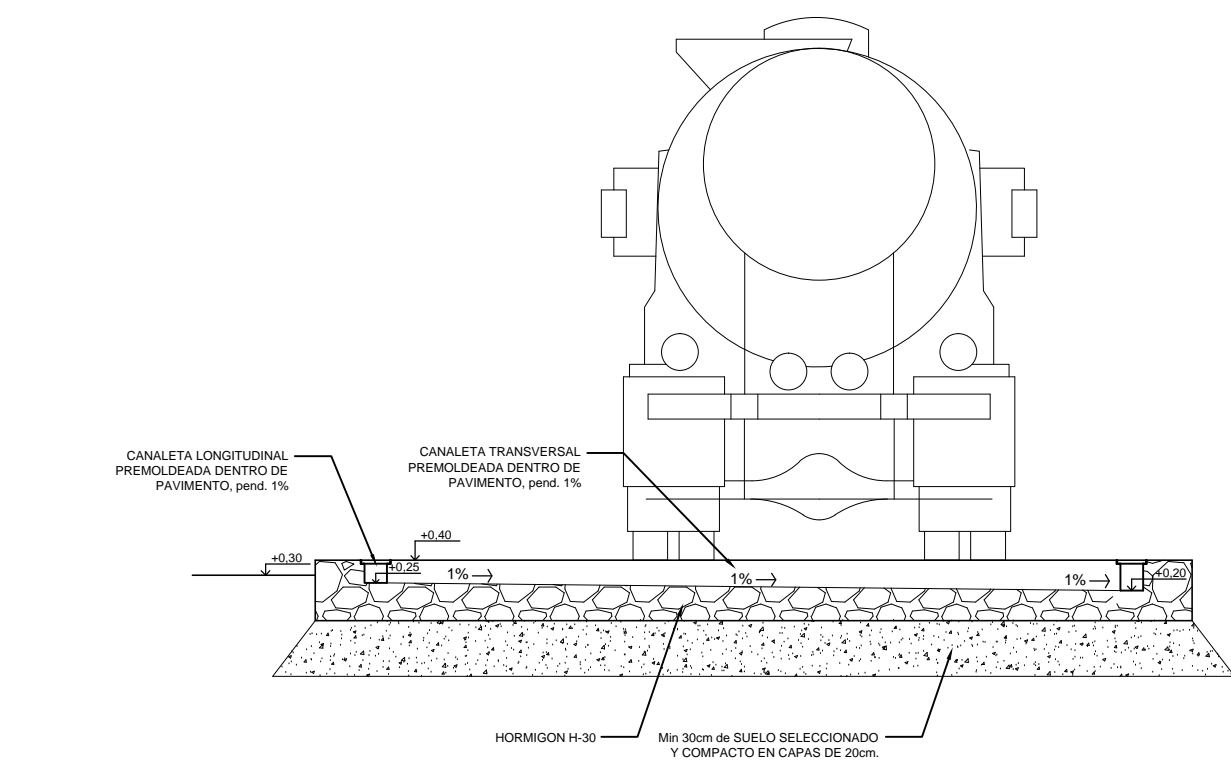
PLATEA DE DESCARGA ZONA CANALETAS TRANSVERSALES
